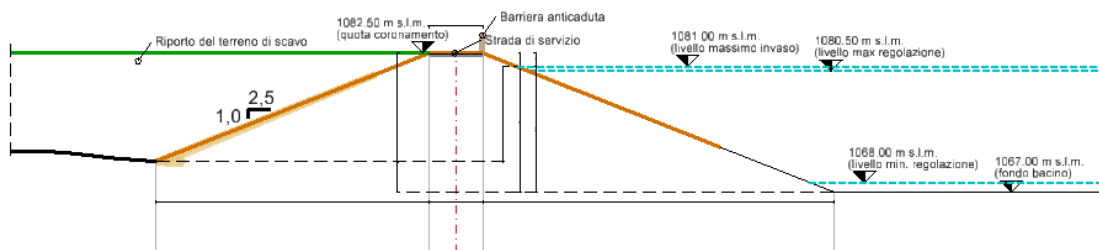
Sezione oggetto di verifica (Sezione A-A).
